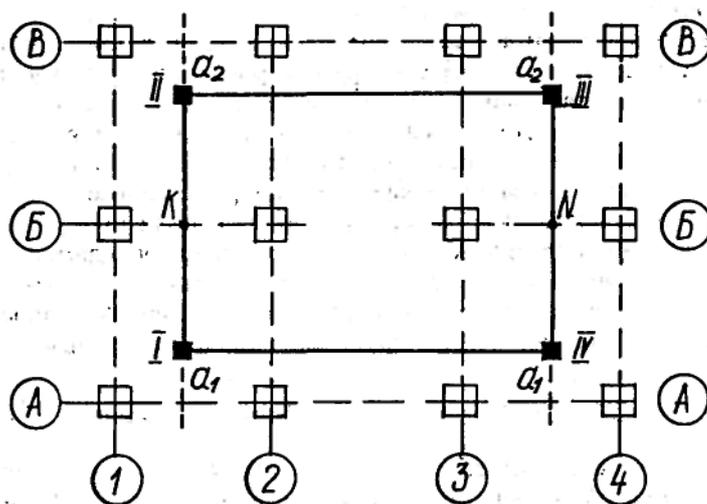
Схема детальной разбивки осей колонн здания
